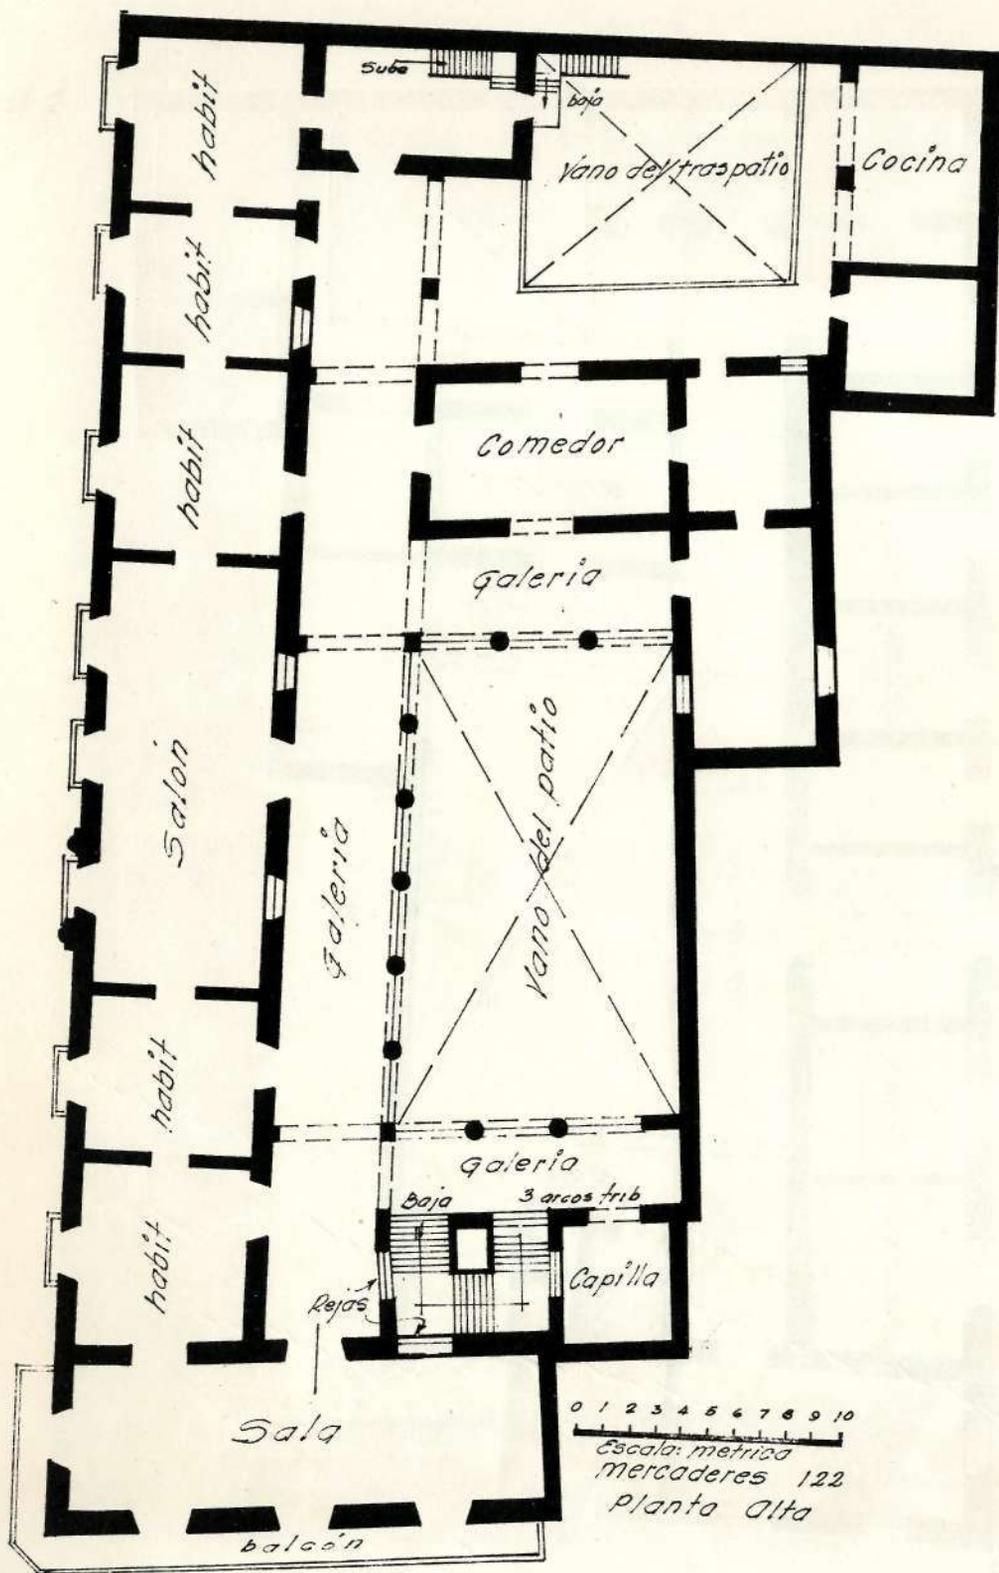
A Planta alta de la casa de Calvo de la Puerta.
